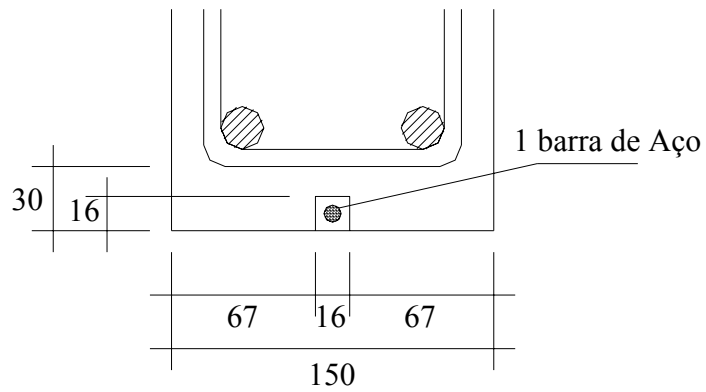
Detalhamento do reforço com 1 barra de aço
